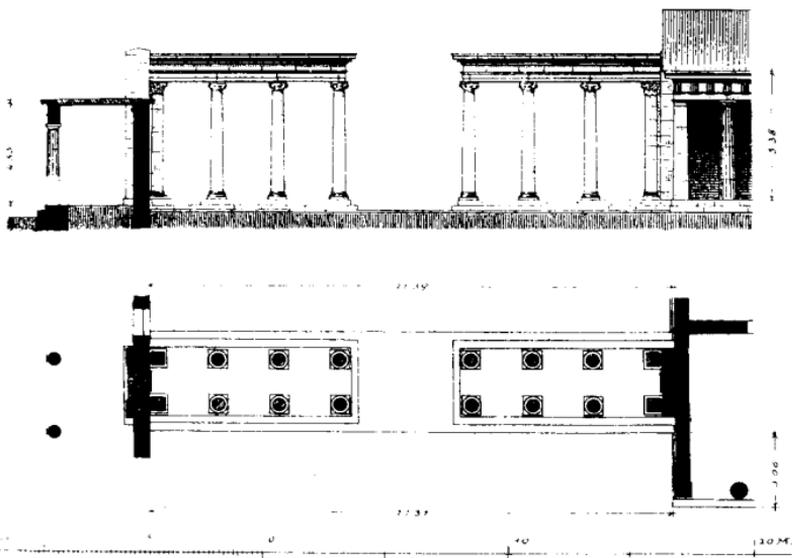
Hafentor. Grundriß und Rekonstruktion
